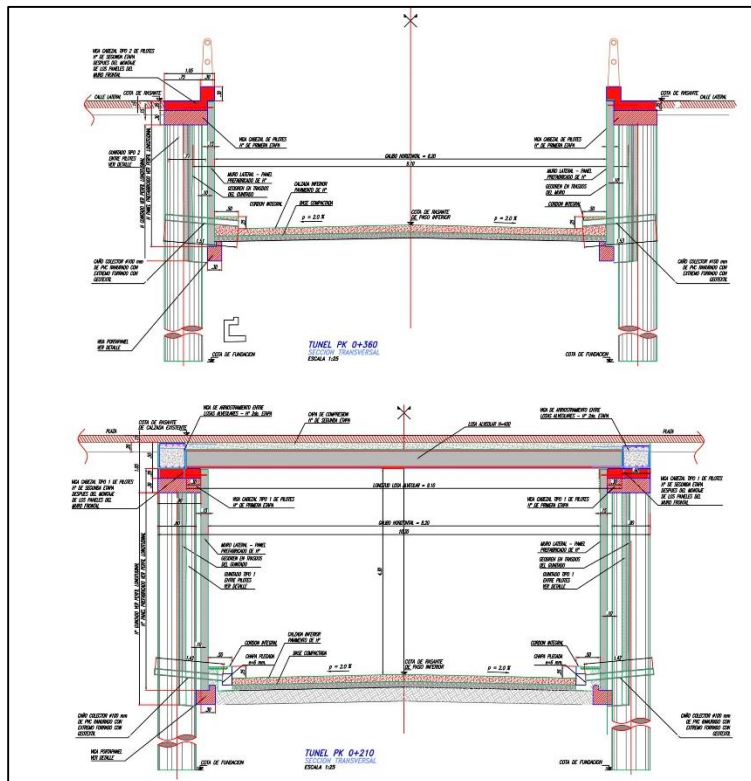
Sección transversal del viaducto en zona de pilotes en trinchera y túnel. (PLANO N° 5)
